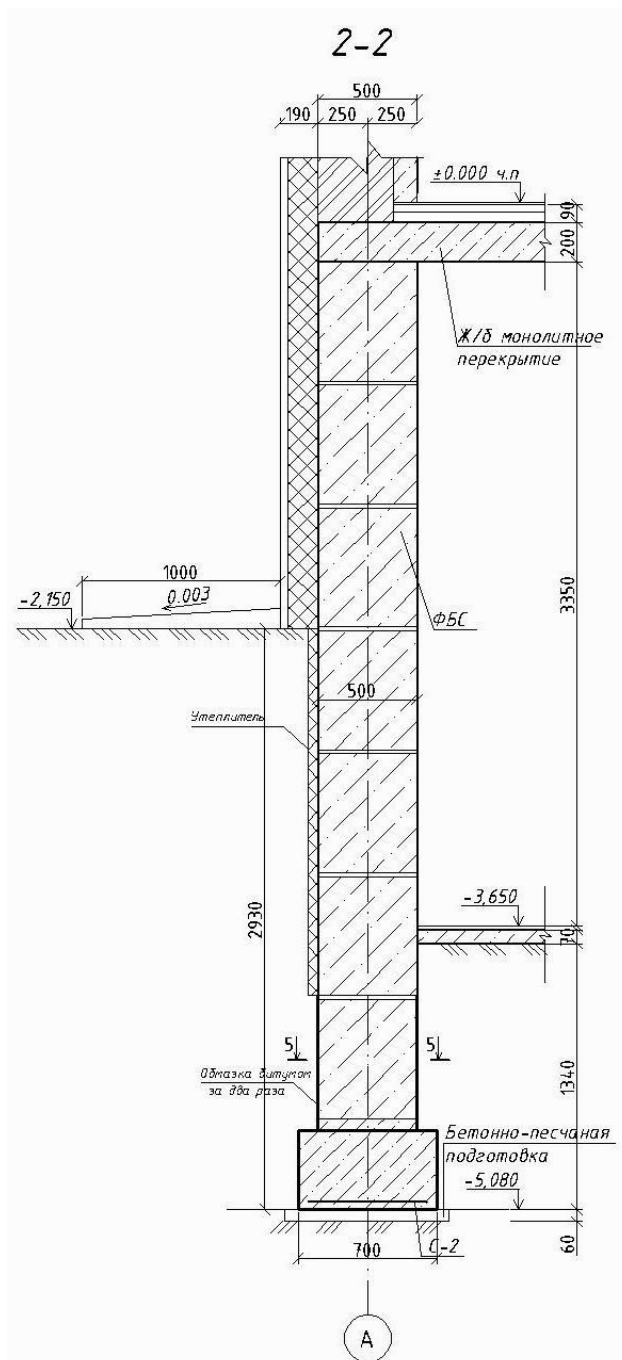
Конструктивная схема ленточного монолитного фундамента цокольного этажа в сечении 2-2
